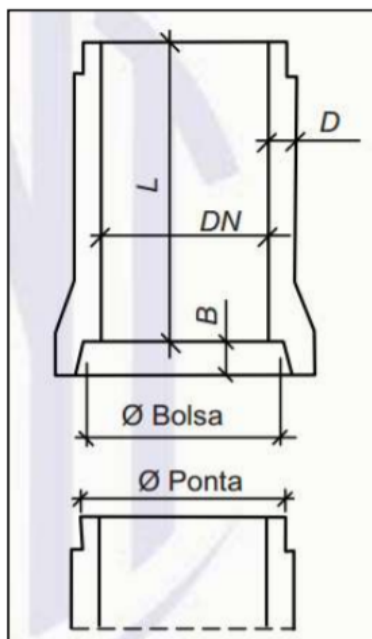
Corte longitudinal típico de tubo com encaixe ponta e bolsa.
